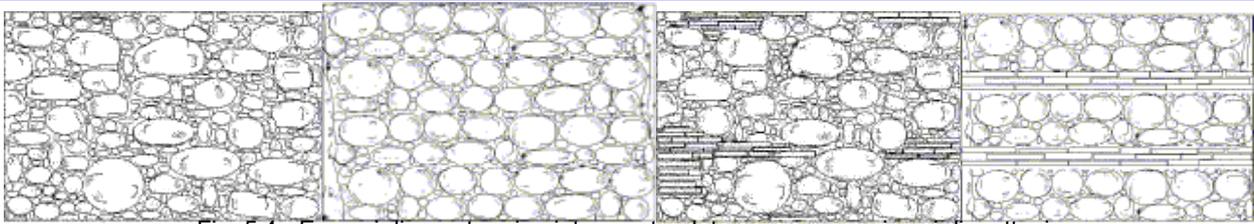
Esempi di murature in pietra arrotondata senza e con ricorsi di mattoni
